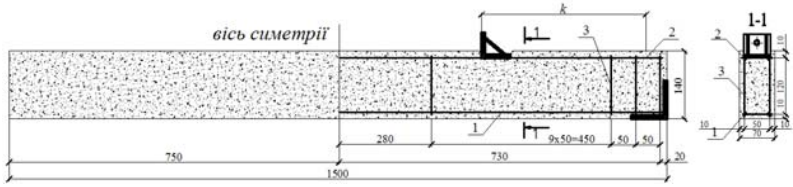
Схема армування експериментальних зразків балок, підсилені ВСС, де 1 і 2 – нижня A_{s2} і верхня A_{s1} поздовжня арматура; 3 – поперечні стержні A_{sw}
